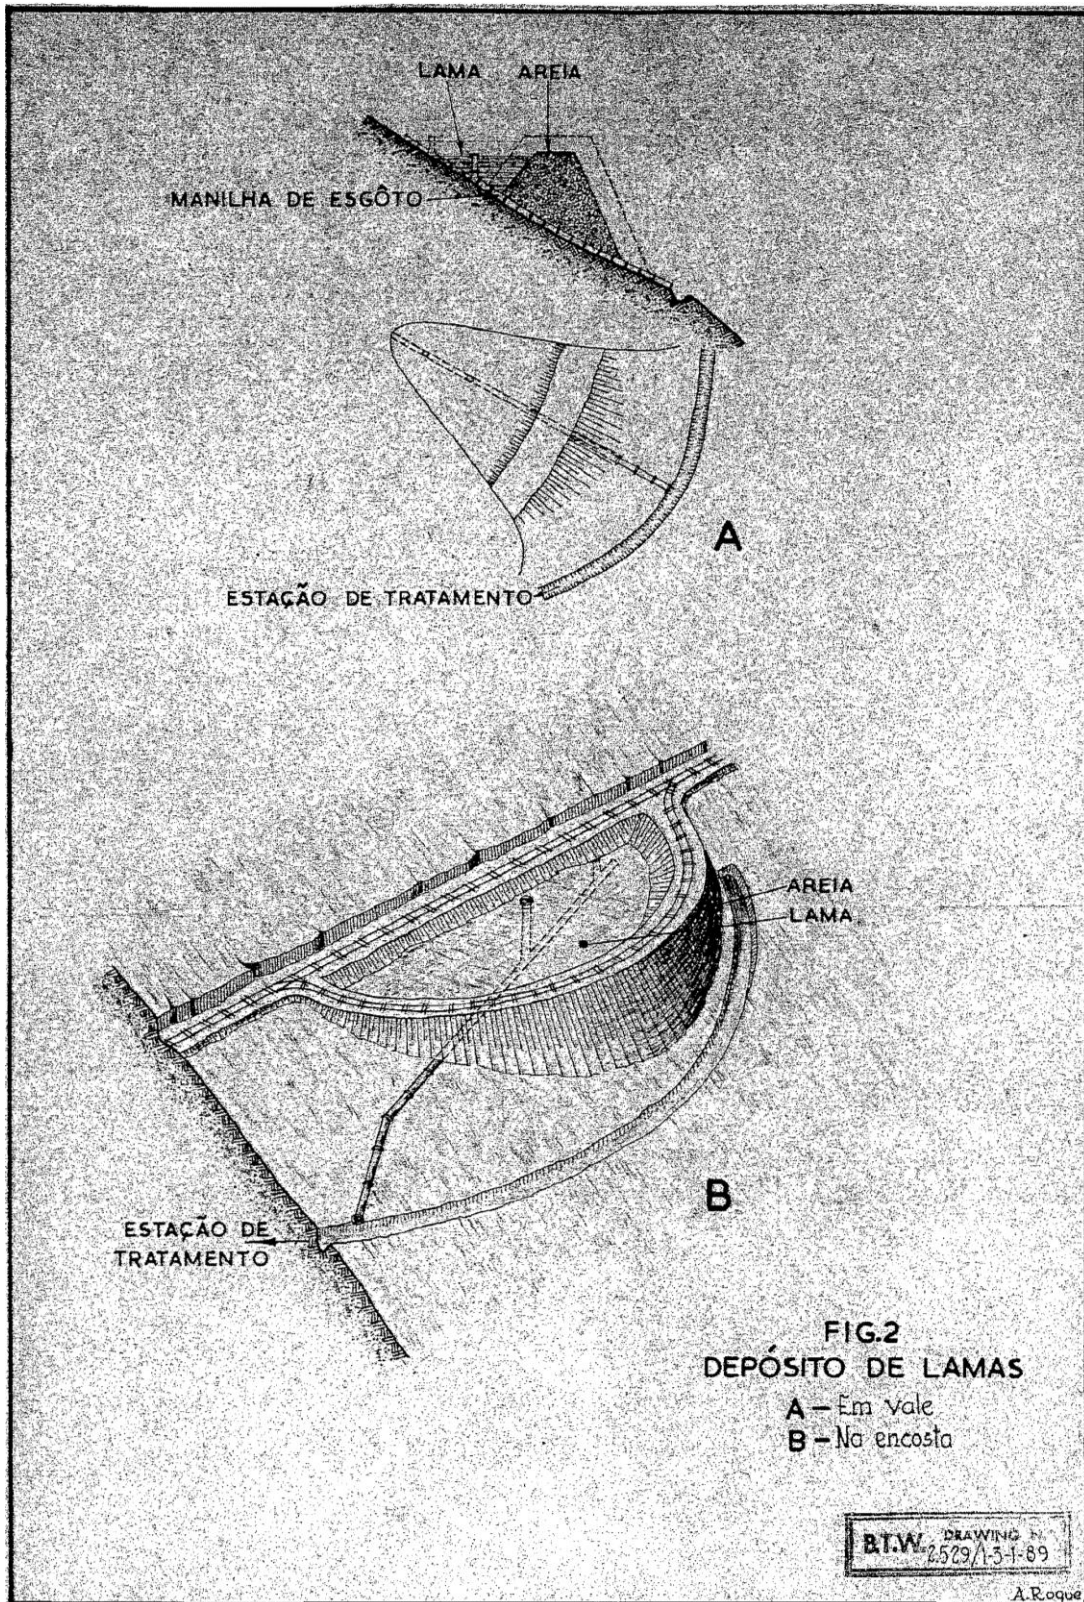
Esquema de construção e drenagem da barragem de lamas, do arquivo da empresa Beralt.
